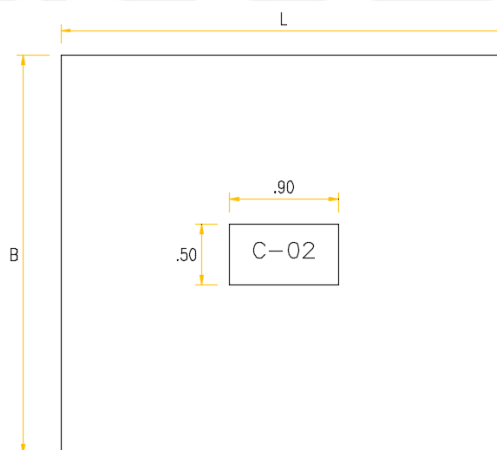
Dimensiones teóricas de la zapata aislada.
